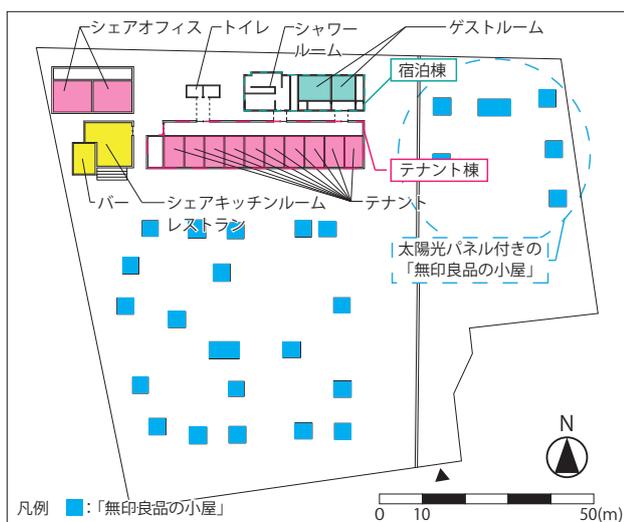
配置図兼平面図(参考文献4)5)を参考に筆者が作成
